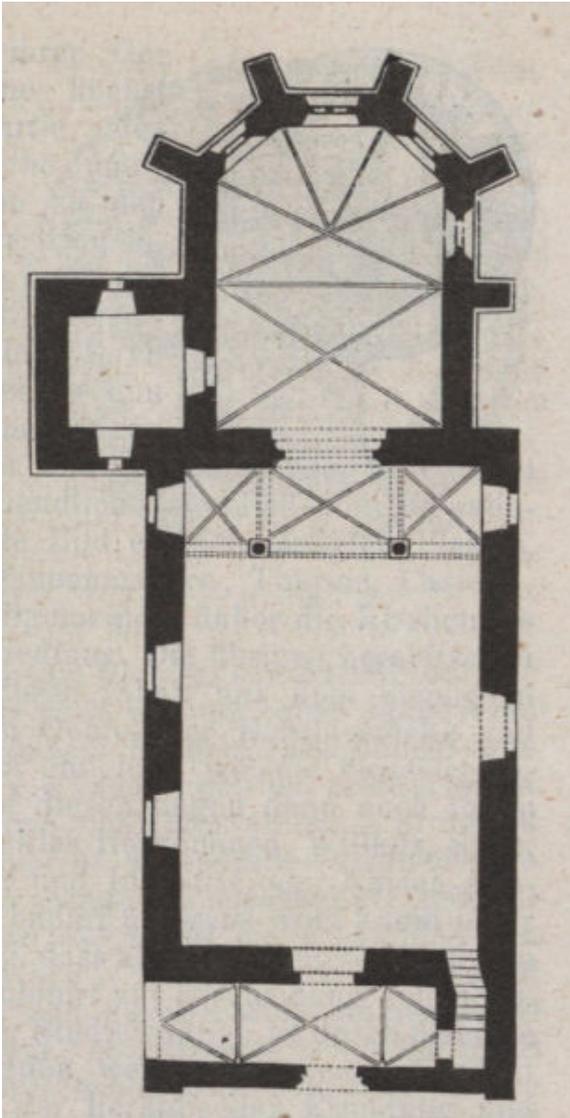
Unbekannt: Grundriss, 1871.
